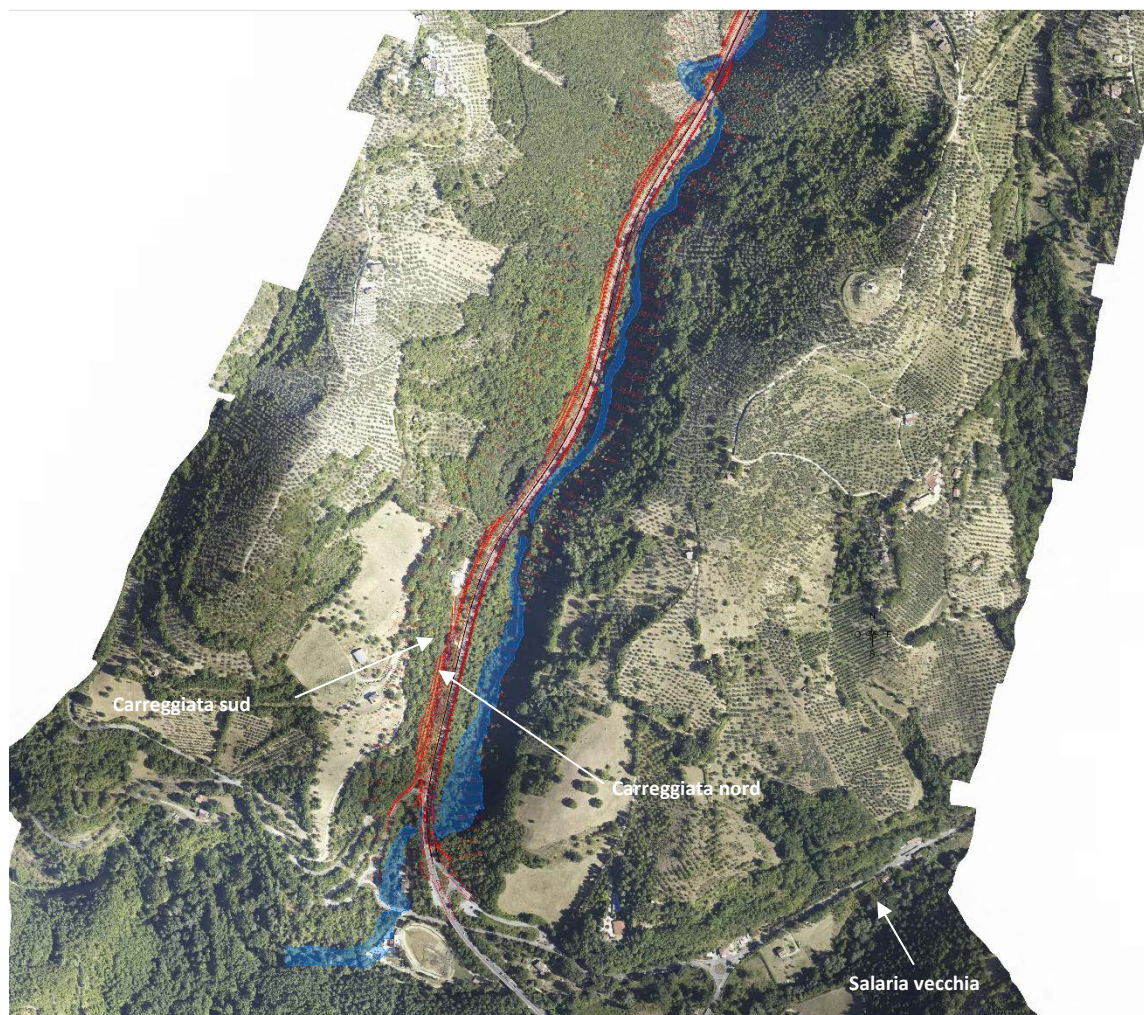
Lotto 1: tracciato di progetto su ortofoto dalla pk 0+000 alla pk 1+300
